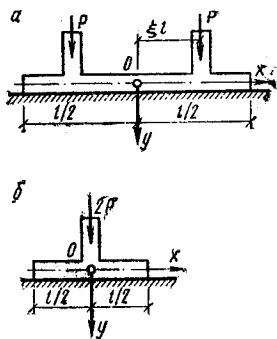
Расчетные схемы коротких балок при загрузении
